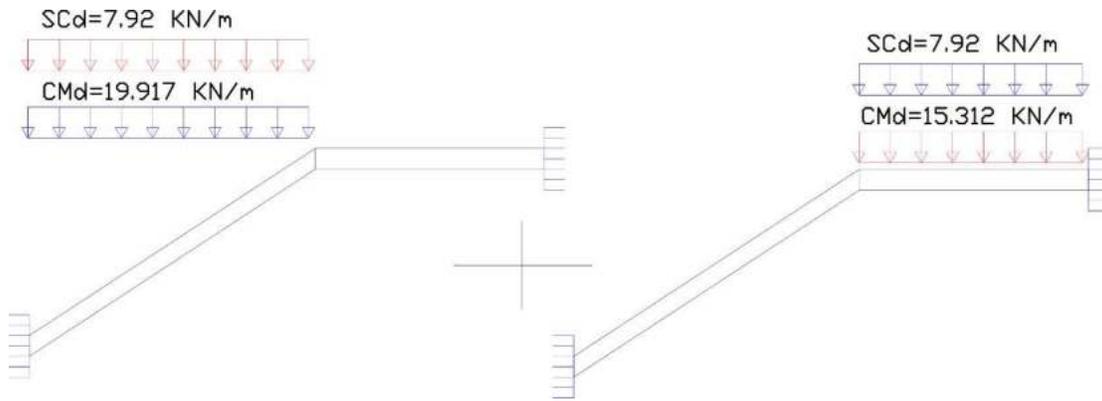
Consideración de la escalera para el cálculo de la armadura negativa.
